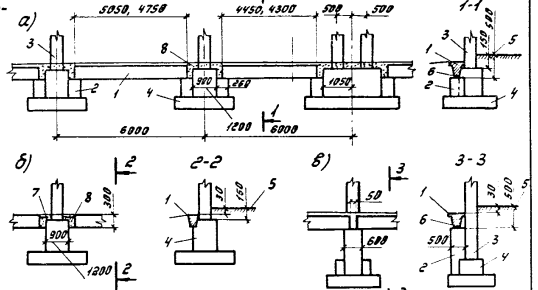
Опирание фундаментных балок при шаге колонн 6 м а-при неглубоком заложении фундаментов; б-при опирании балок арматурными выпусками на обрезы фундаментов (для панельных стен); в-при глубоком заложении фундаментов; 1-фундаментная балка; 2-бетонный столбик; 3-колонна; 4-фундамент; 5-пол цеха; 6-слой цементного раствора, толщиной 20 мм; 7-арматурные выпуски; 8-бетон или цементный раствор.
